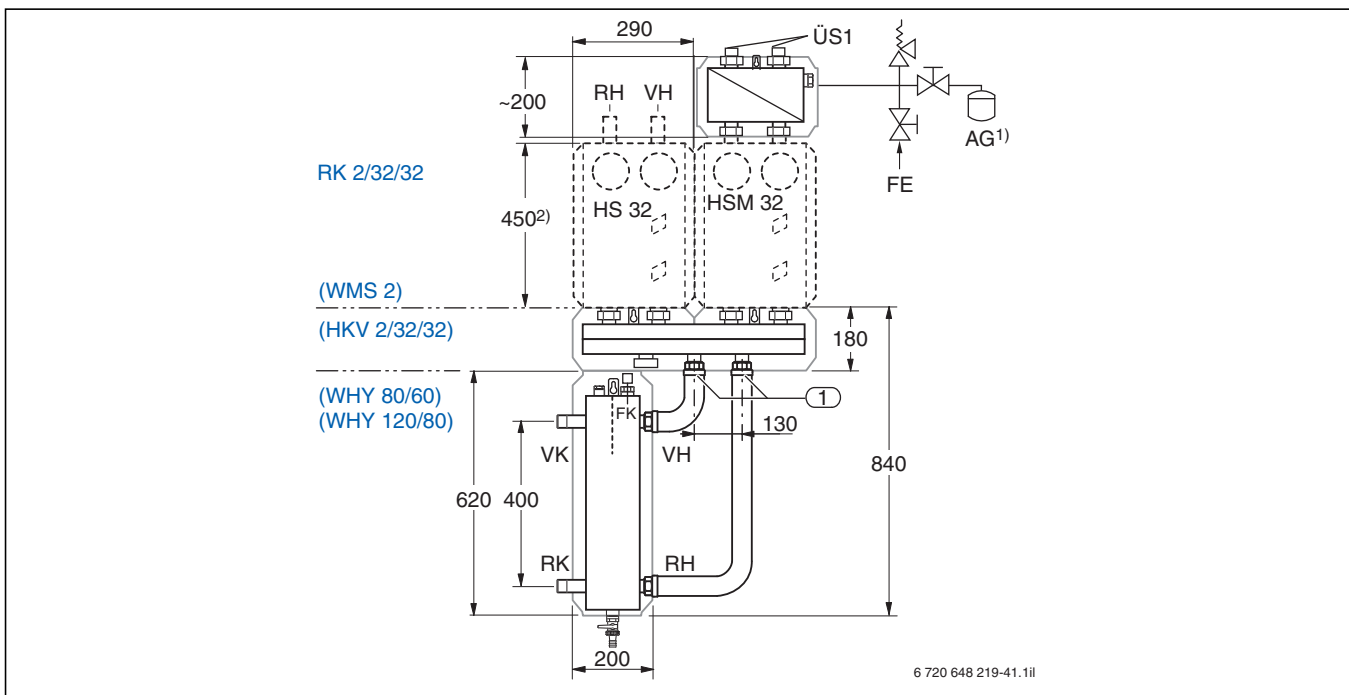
Abmessungen Systemtrennungs-Set mit Bauteilen DN 32 (Maße in mm)
